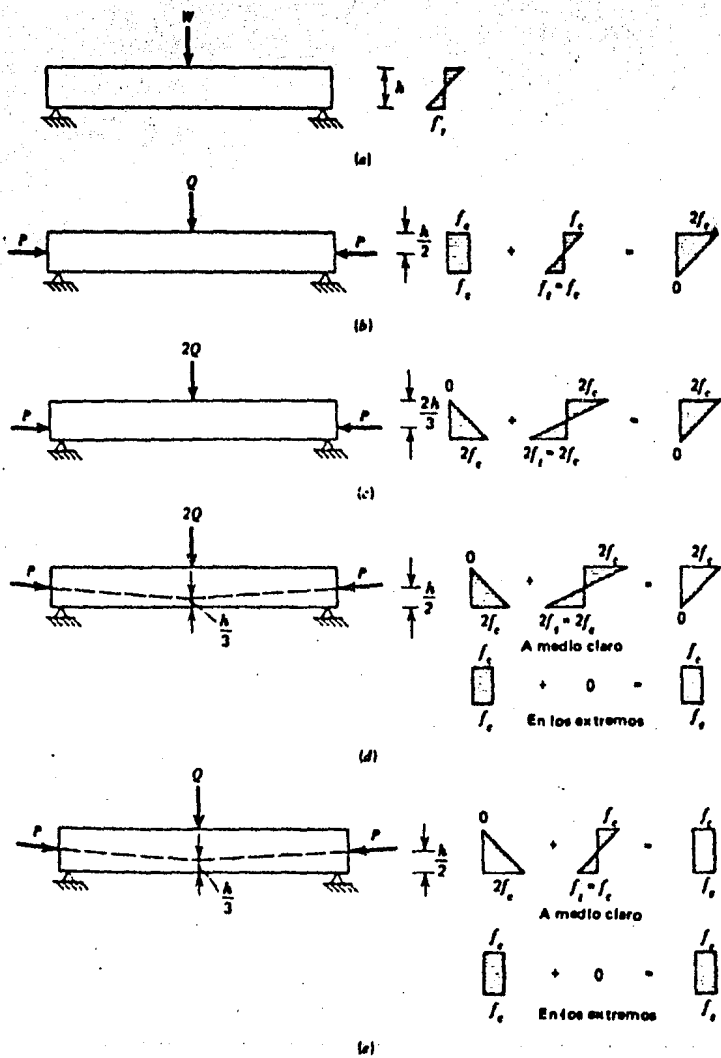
Esquemas alternativos para presforzar una viga rectangular de concreto. a) Viga de concreto simple. b) Viga presforzada axialmente. c) Viga presforzada excéntrica. d) Viga presforzada con excentricidad variable. e) Etapa de carga balanceada para viga con excentricidad variable.
